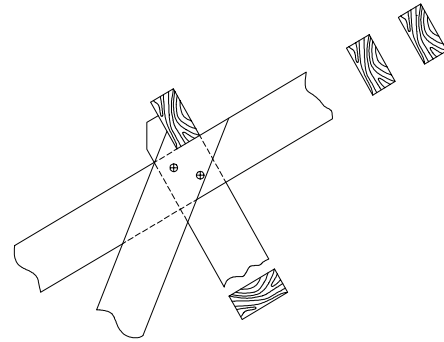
Ligação do banzo superior de treliça tipo Belga.
